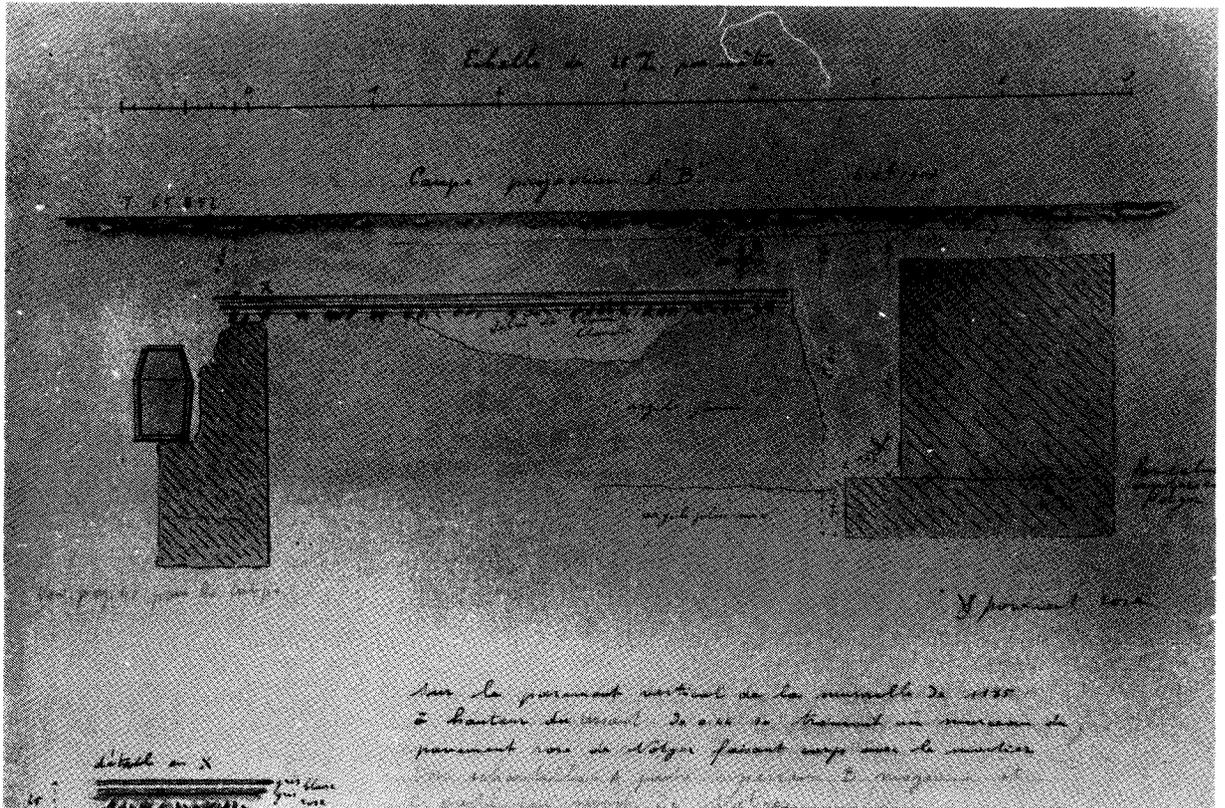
Extrait du manuscrit de P. LOHEST, page 61. Coupe dans la nef montrant les sols pré-ottoniens détruits par la fondation ottonienne et passant sur un mur romain.
